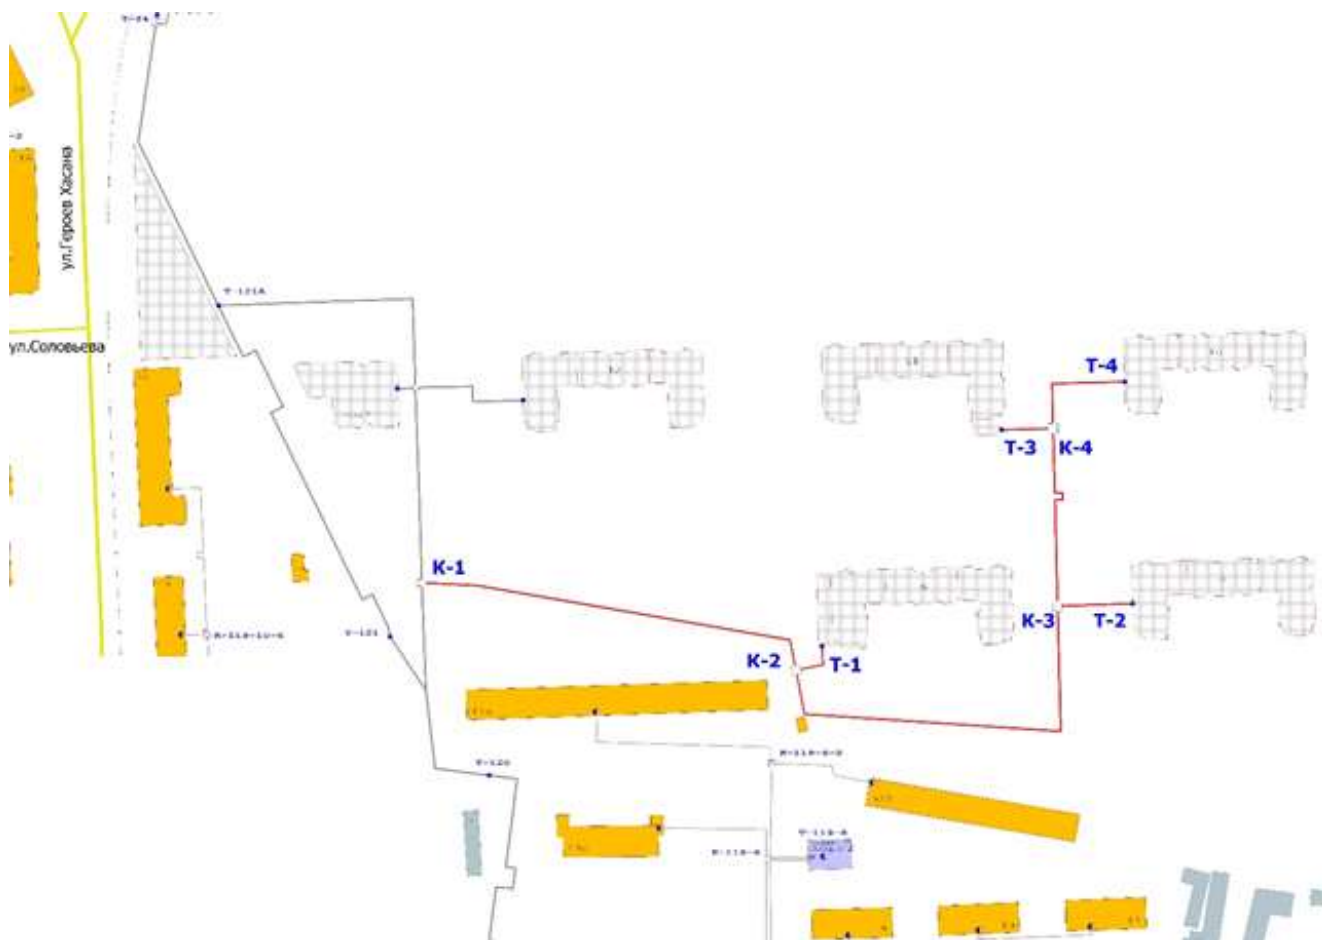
Ситуационный план развития системы теплоснабжения «Комплекса многоквартирных жилых домов по ул. Красные казармы, кв.272.»
